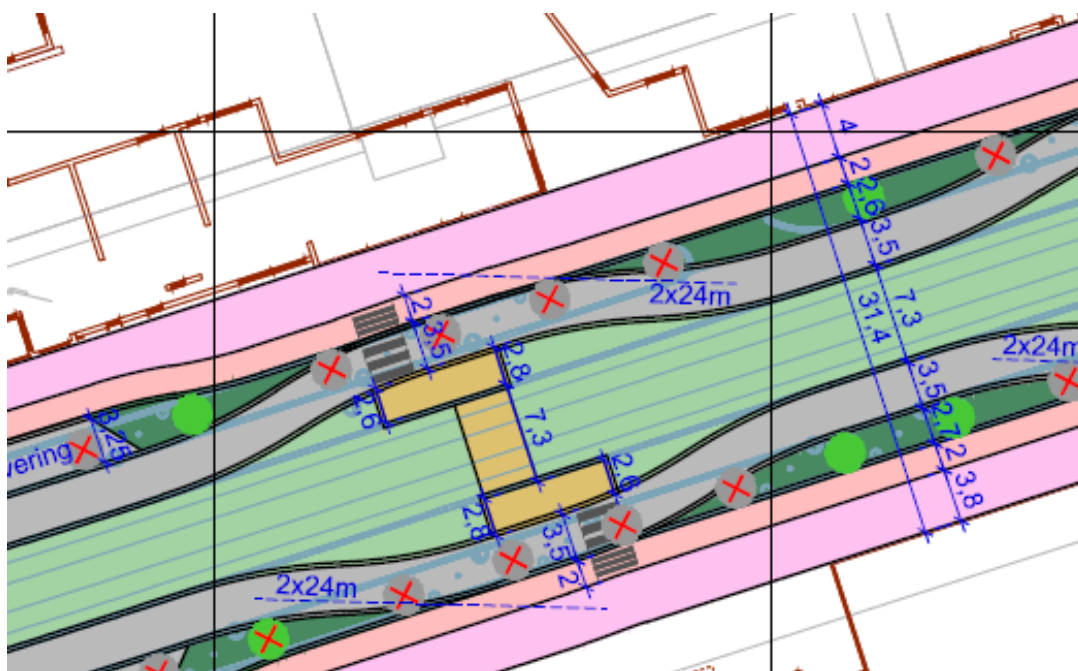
Illustrasjon av hvordan Kanalveien vil se ut med alternativ 1A. Den røde firkanten viser planområdet med tre planlagte kryssinger.
